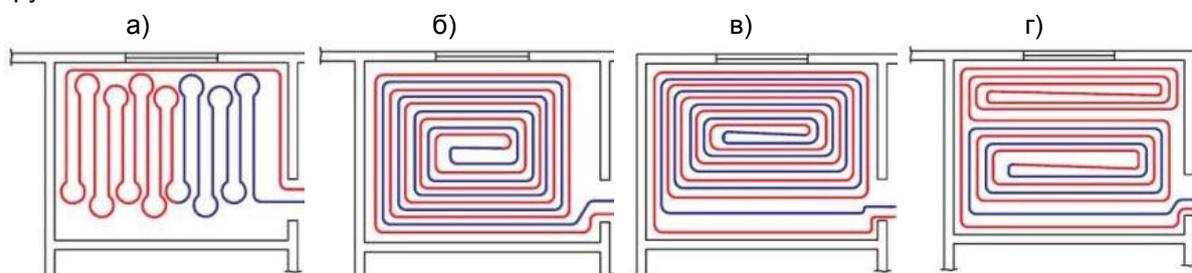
Способы укладки труб при напольном отоплении: а – зигзагообразный; б – с двойной проводкой; в – с переменным шагом укладки труб; г – с дополнительным греющим контуром
